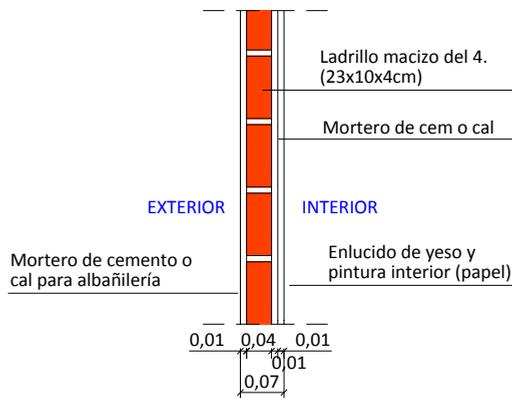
Detalle constructivo tipo del cerramiento exterior de la parte trasera de la vivienda.
